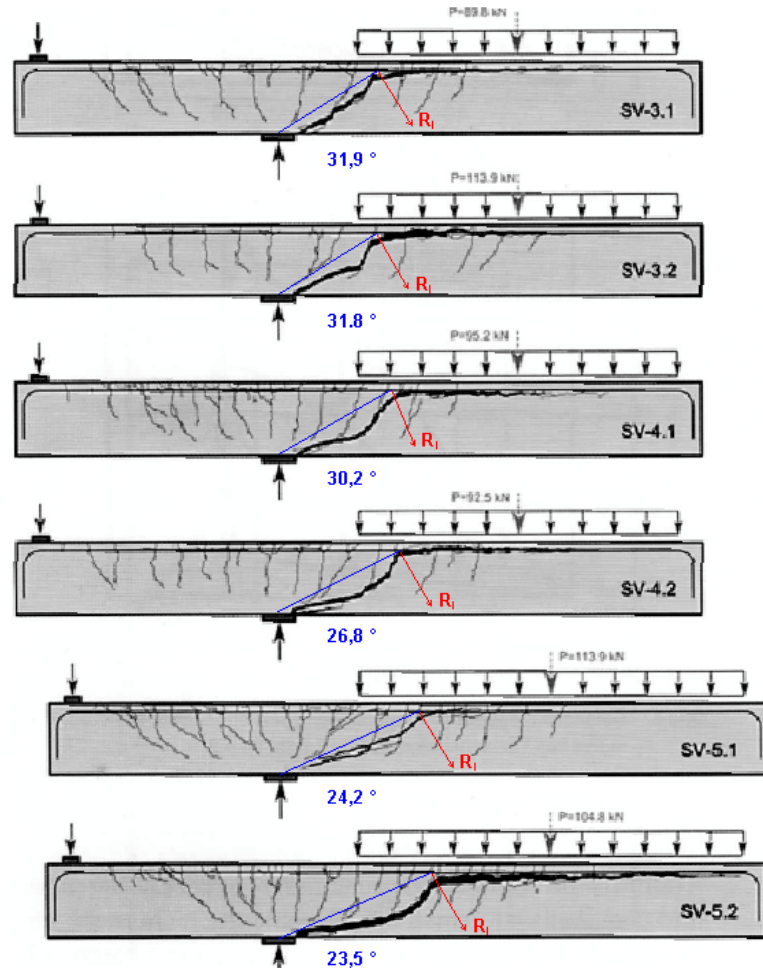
Balken SV-3.1 bis SV-5.2 aus [3] mit eingetragenen Zug- und Druckstreben
